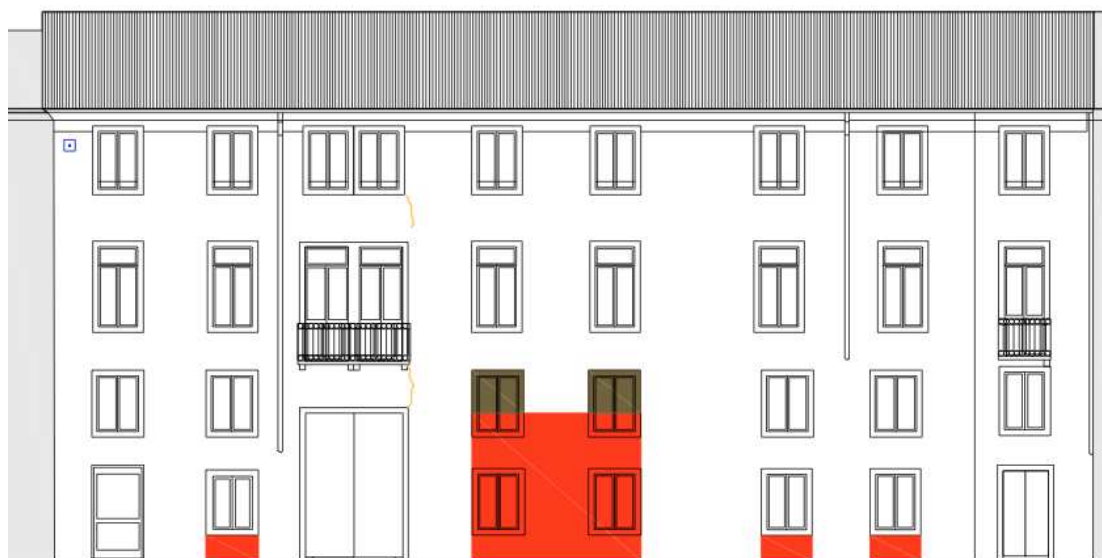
Rilievo critico prospetto principale su via del Santo
